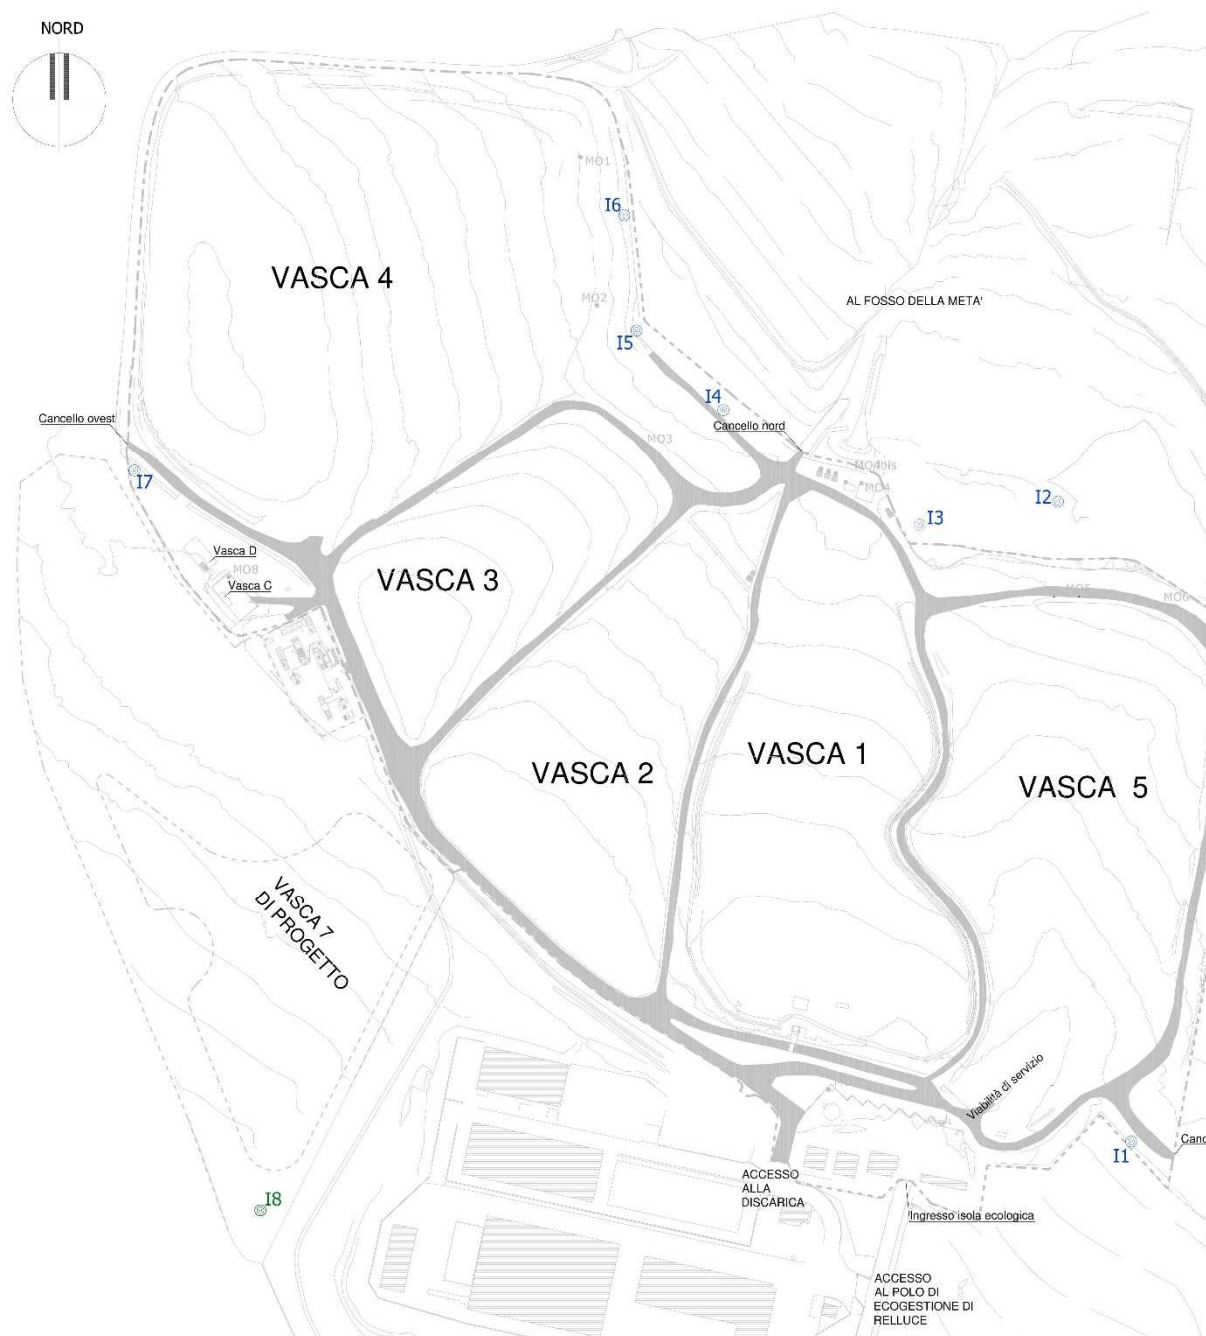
Stralcio planimetrico dei punti di monitoraggio della stabilità (inclinometri)
